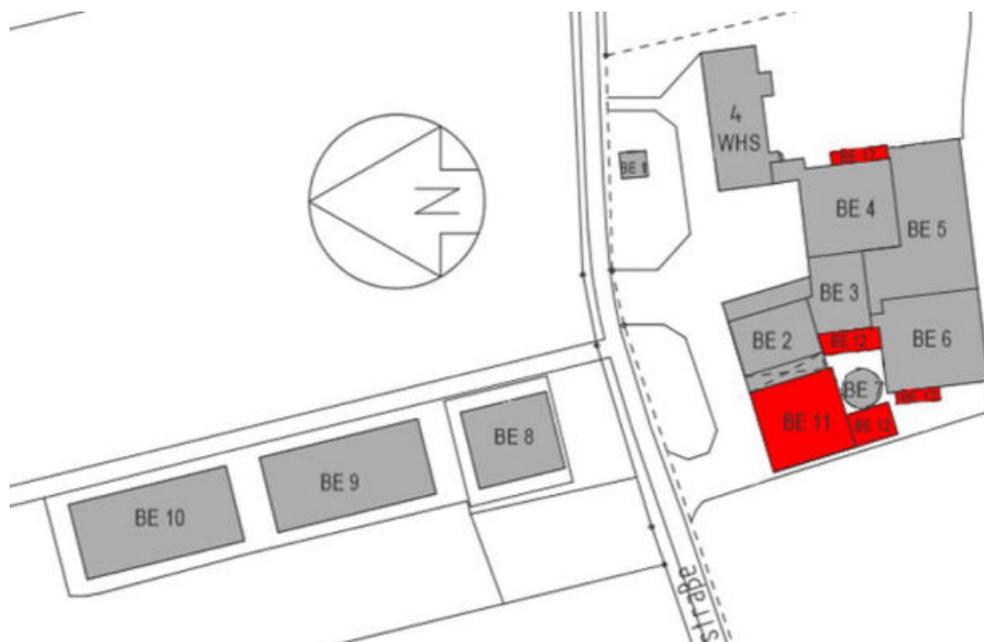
Lageplan mit Darstellung der Betriebseinheiten
